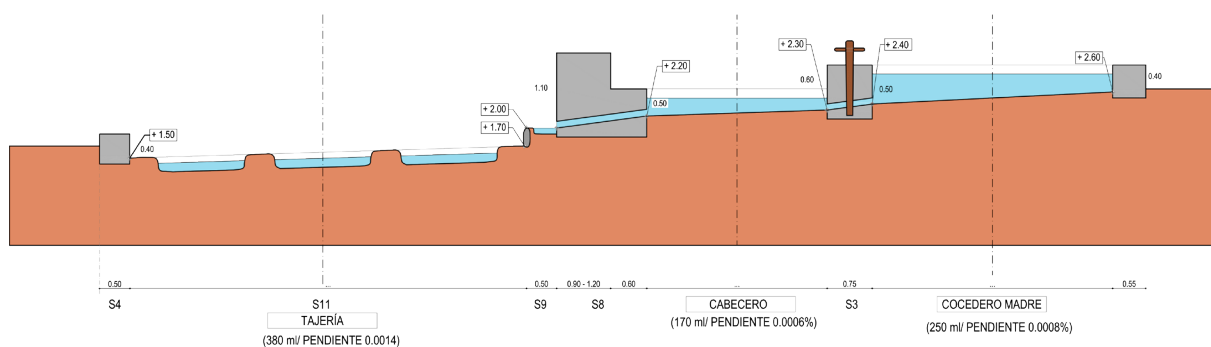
Sección longitudinal de las Salinas del Río. Fuente: Proyecto de ejecución restauración paisajística de las Salinas del Río [4].
